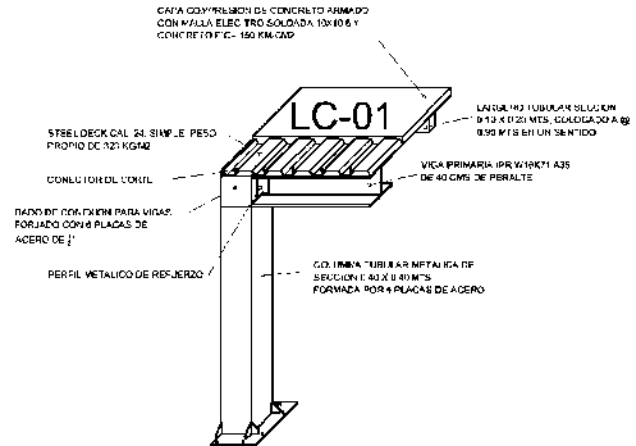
Detalle constructivo realizado por el sustenta. Estructura metálica.
